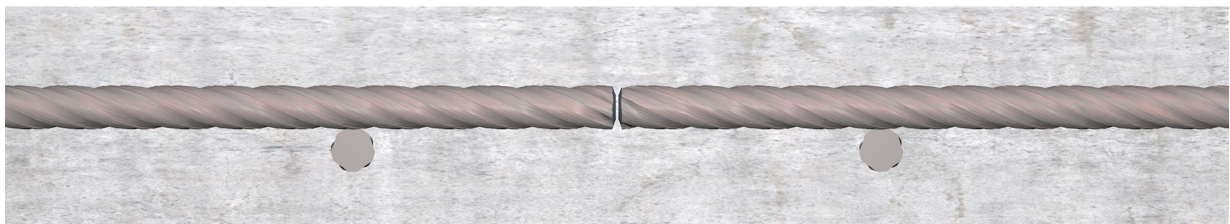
Schematisches Bewehrungslayout mit Bruch
